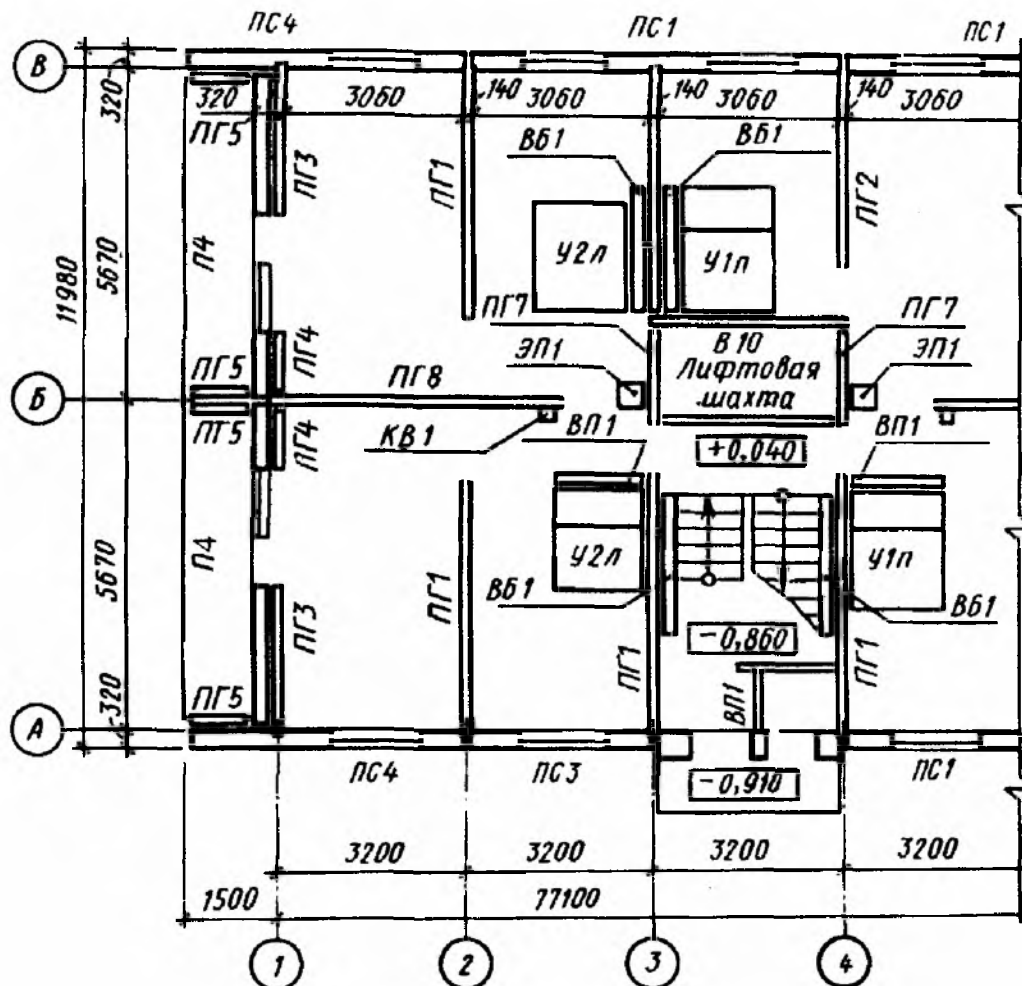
Схема расположения панелей на плане первого этажа жилого дома
